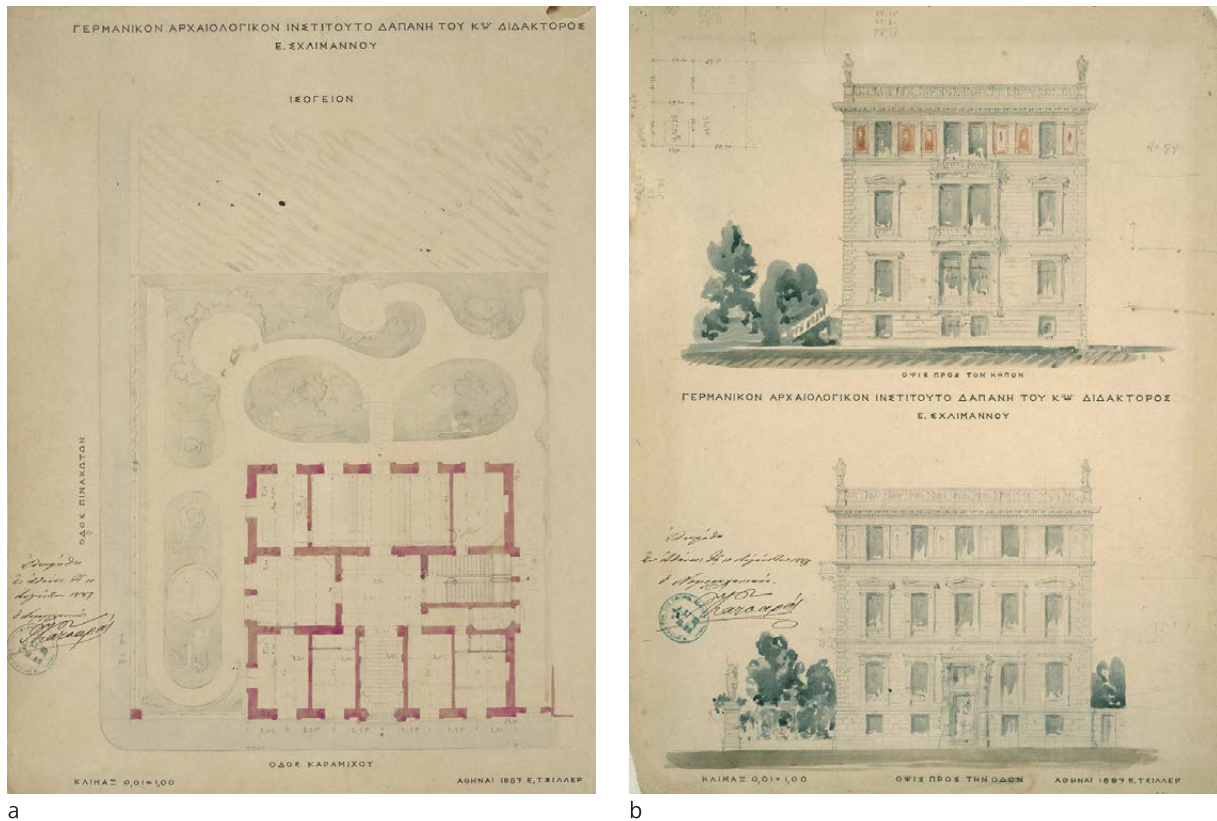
Pläne des Institutsgebäudes nach Ziller: a. Grundriss. – b. Ansichten der Straßen- und Gartenseite
